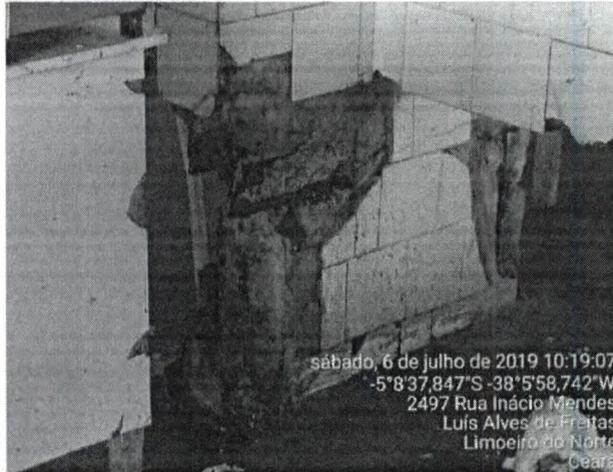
Estrutura de concreto apresentando manifestação patológica de corrosão das armaduras.
